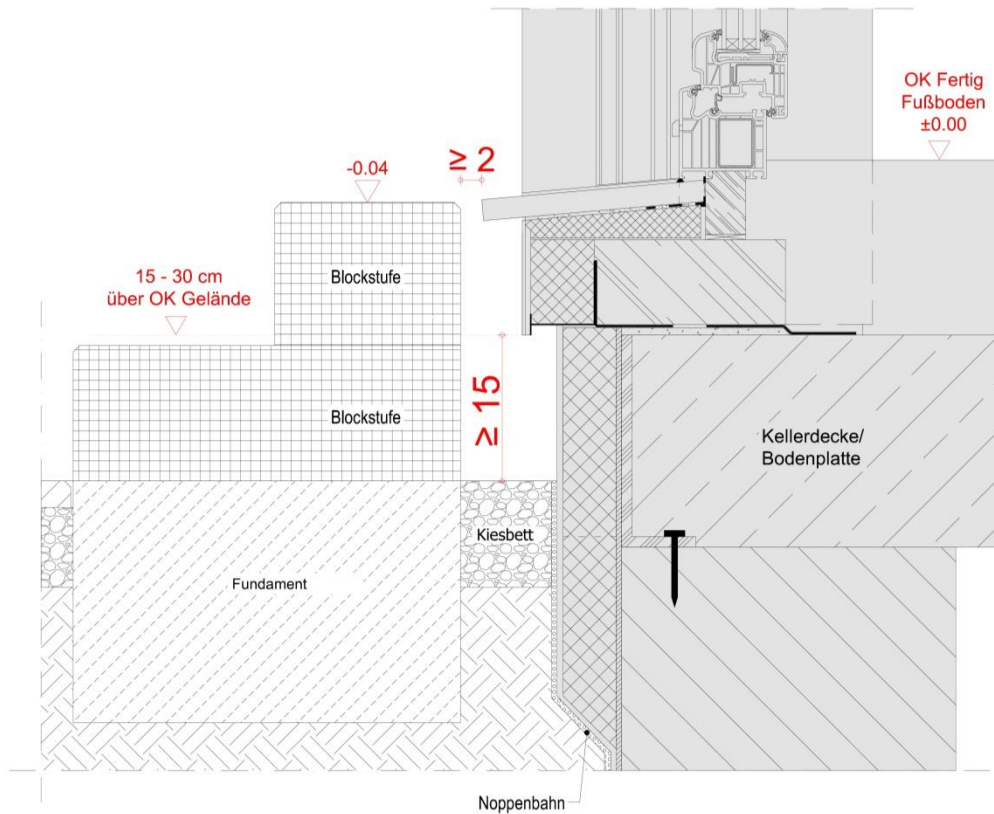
LUXHAUS Sockeldetail 13 - Terrassenbereich mit zwei Blockstufen
